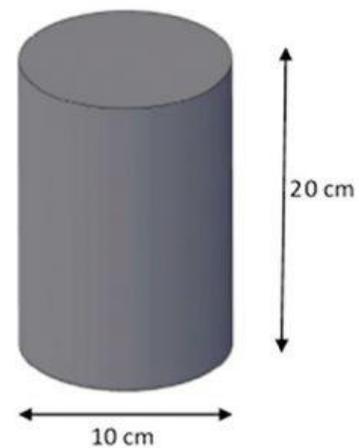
Moldagem do corpo de prova do concreto fresco.
